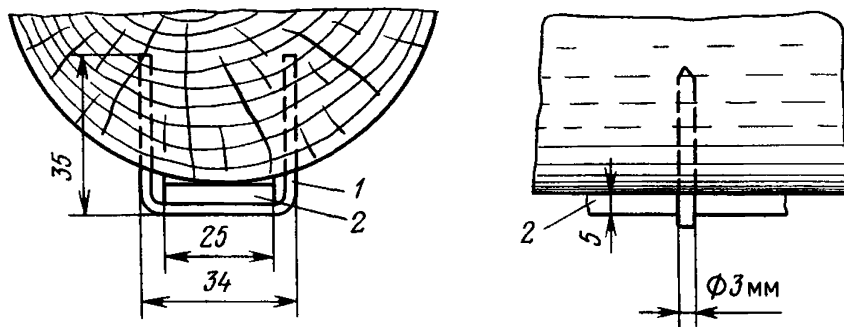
Схема крепления заземляющего проводника в выработке с деревянной крепью:
